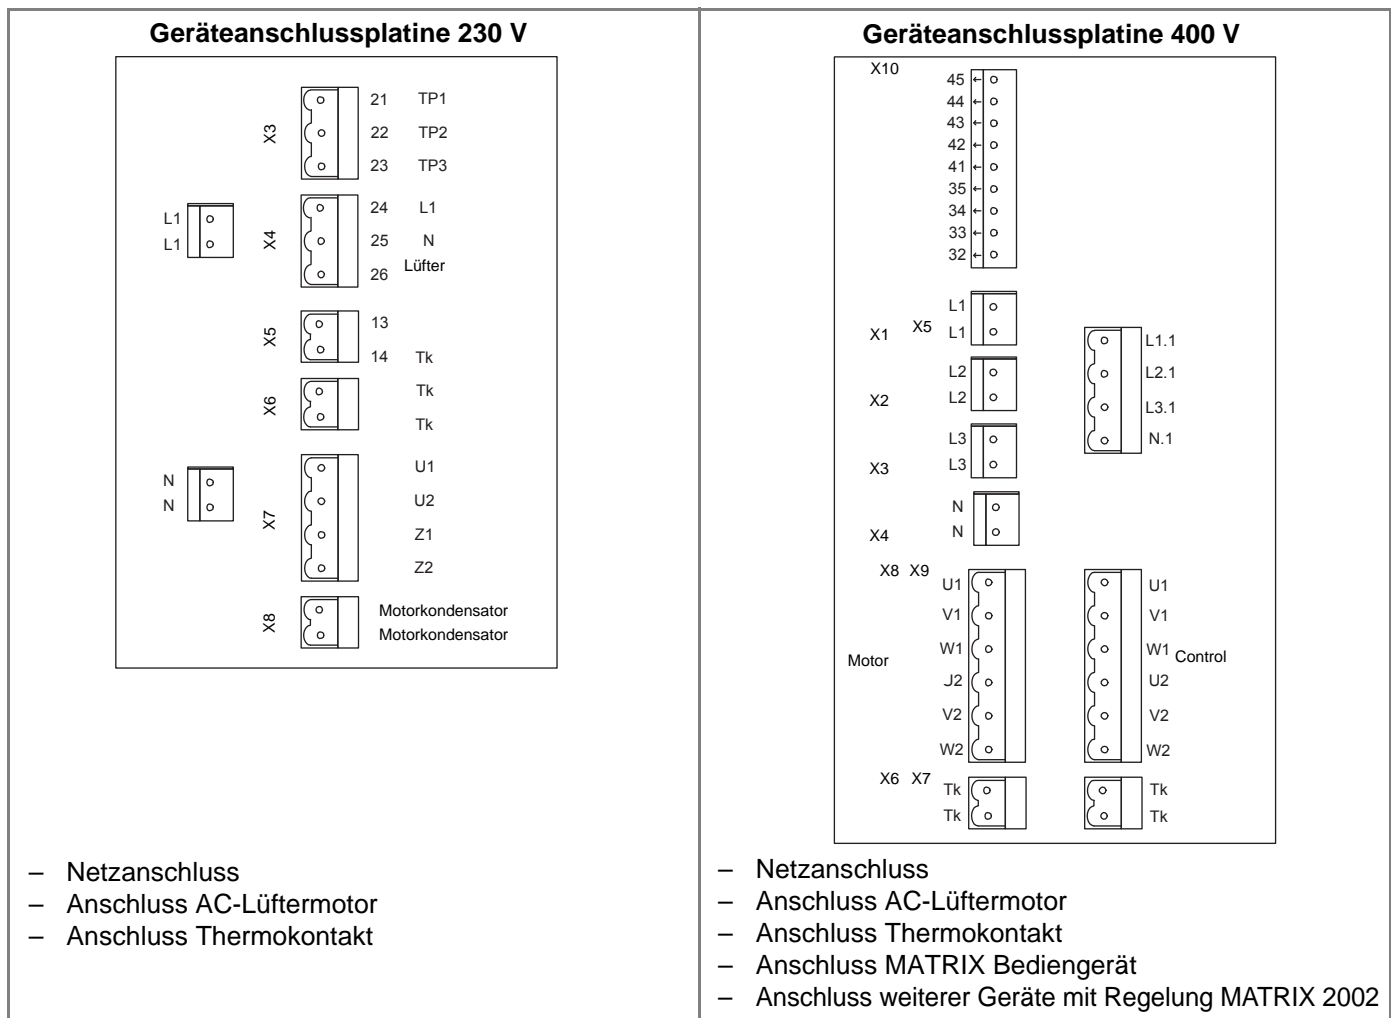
Geräteanschlussplatinen des Gerätes mit AC-Motor 230 V und 400 V
